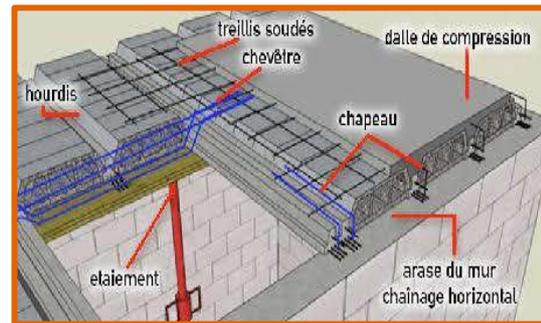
détail sur la mise en œuvre du plancher *Source : cour structure S9
